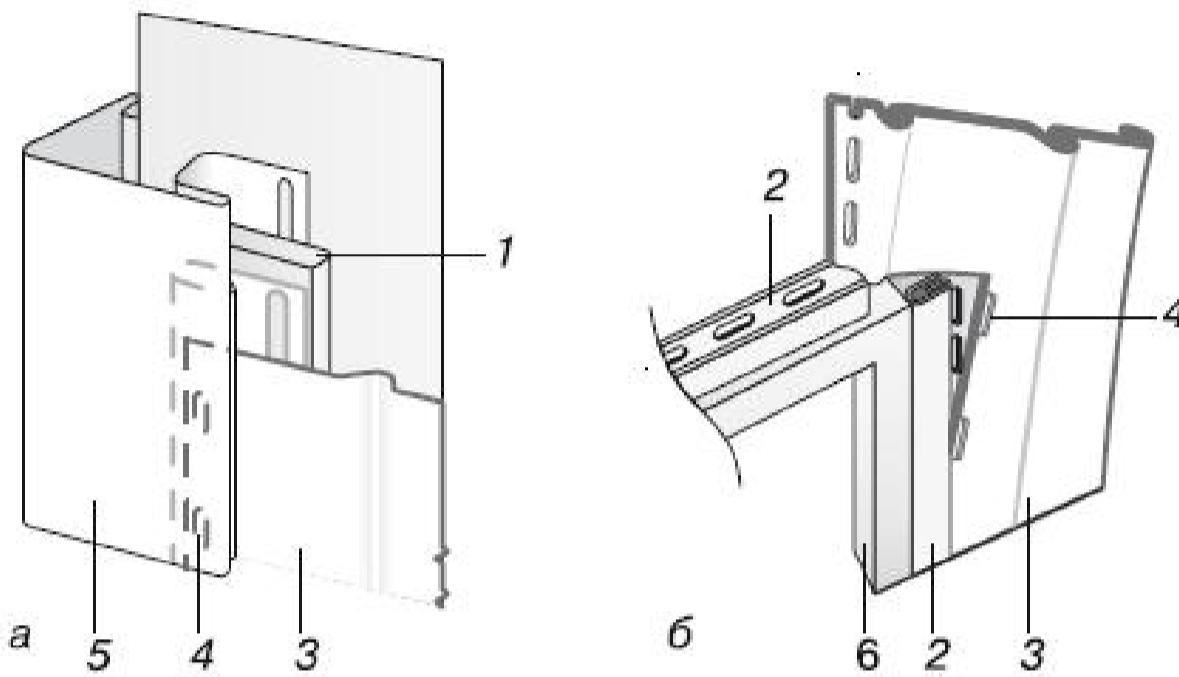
Установка вертикального сайдинга в углах дома и вокруг проемов: а – примыкание к угловому профилю; б – примыкание к обрамлению проемов; 1 – деревянная рейка; 2 – J-профиль; 3 – рядовая панель; 4 – зацепы, 5 – угловой профиль; 6 – проем
